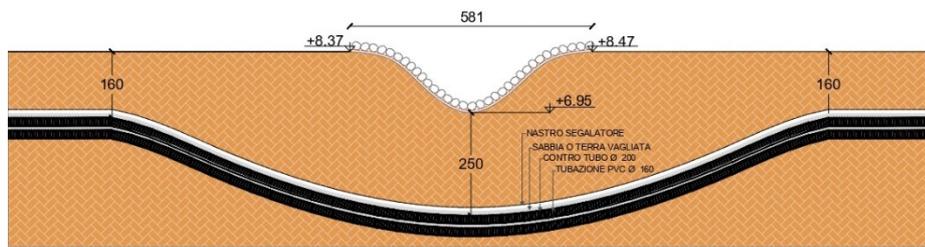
Sezione tipo dell'attraversamento del canale di scolo
